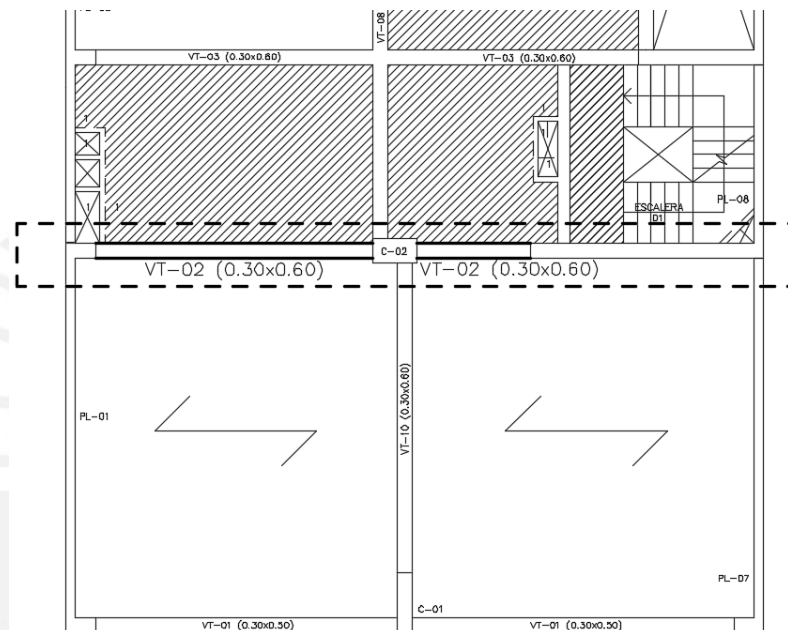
Ubicación en planta de la viga VT-02 del ejemplo.
